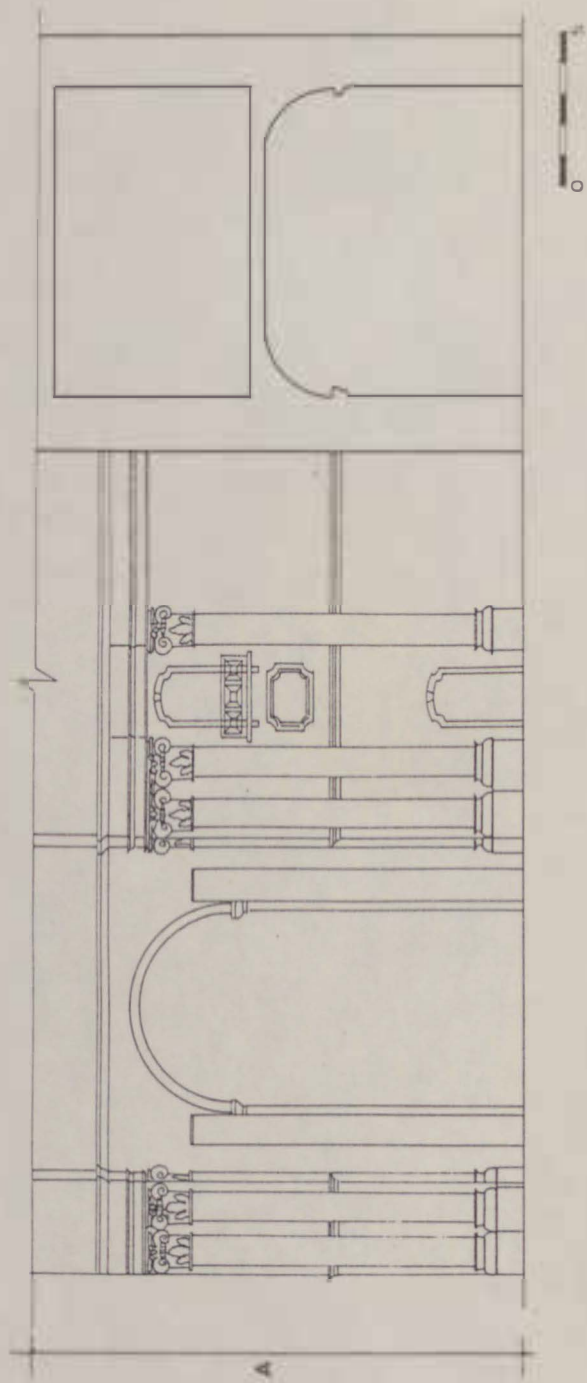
Estudo para corte longitudinal - lado do Evangelho.
